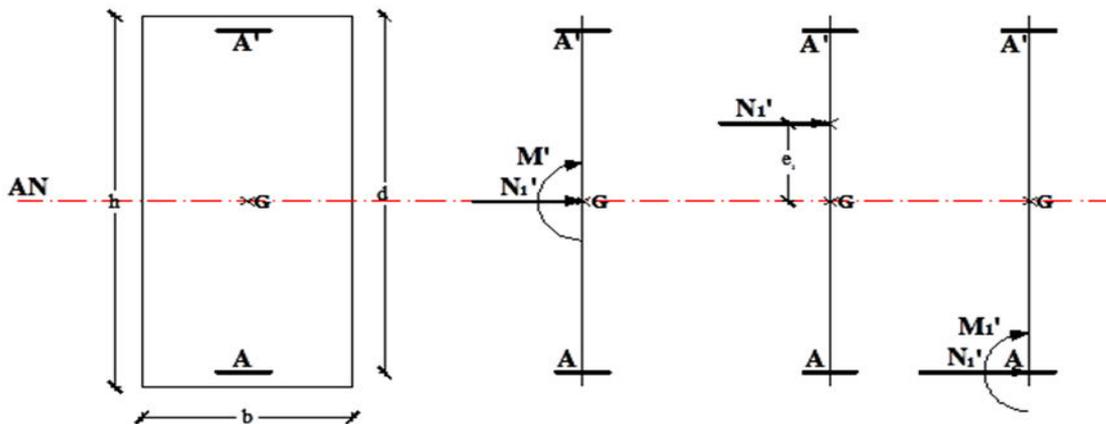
Position de N_1' , M_1' et M_1 sur la section transversale.
